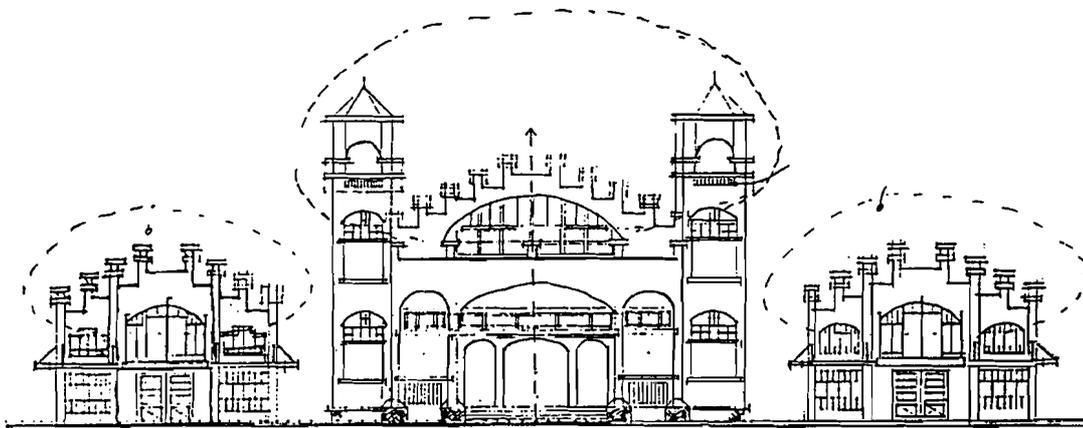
Ornament Pada Bangunan Stasiun KA
